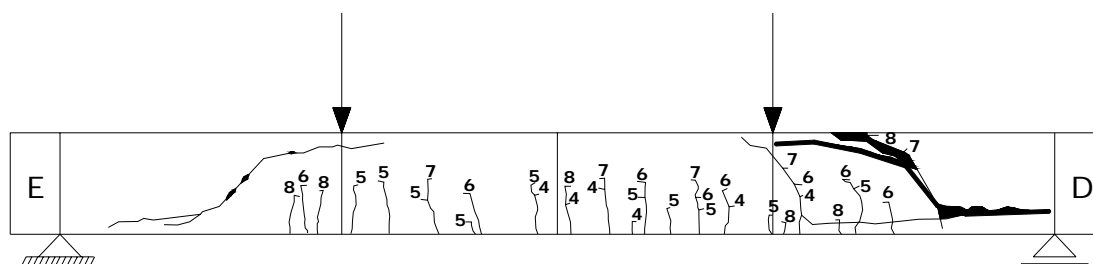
Padrão de fissuração para a viga V60-1 sem armadura transversal
